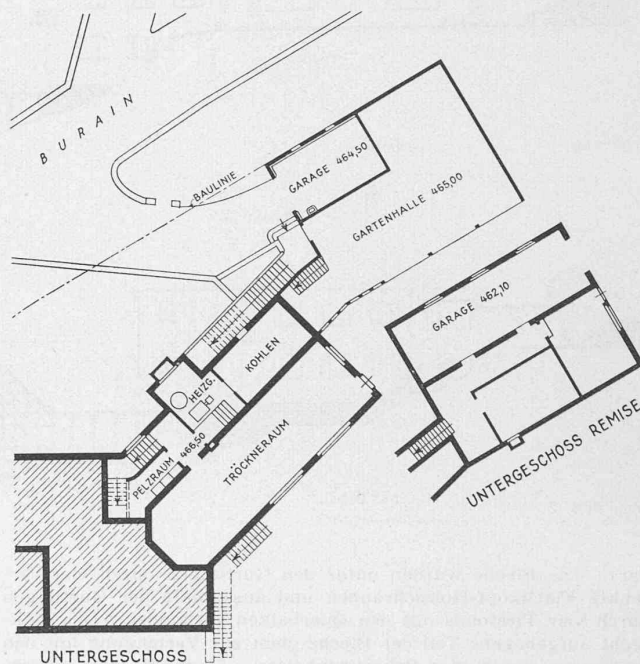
Grundrisse der Untergeschosse. — Masstab 1:400
